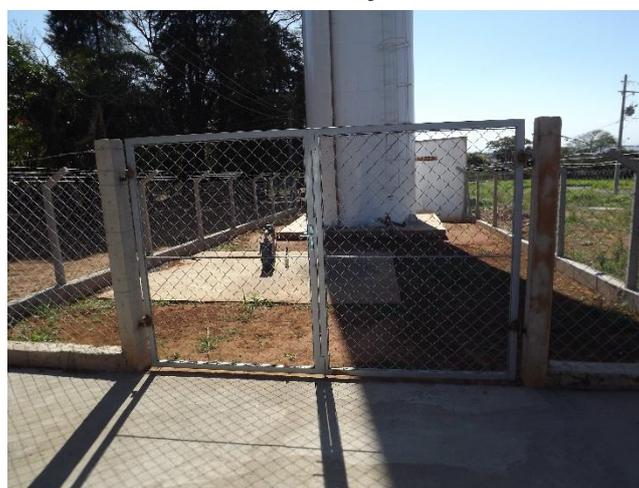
Detalhe do Poço Jardim Paraíso em área cercada.
